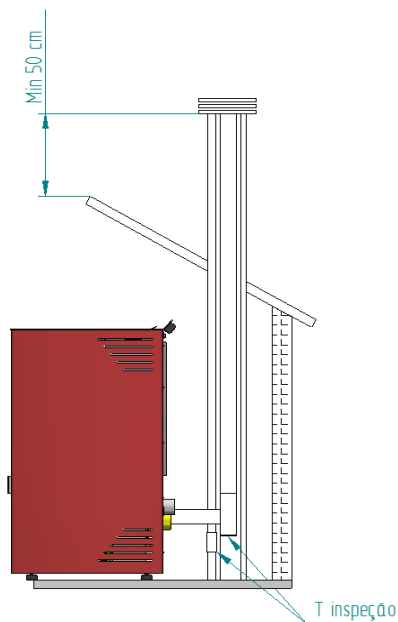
Vista lateral da instalação com chaminé, com exemplo do ponto de inspeção
